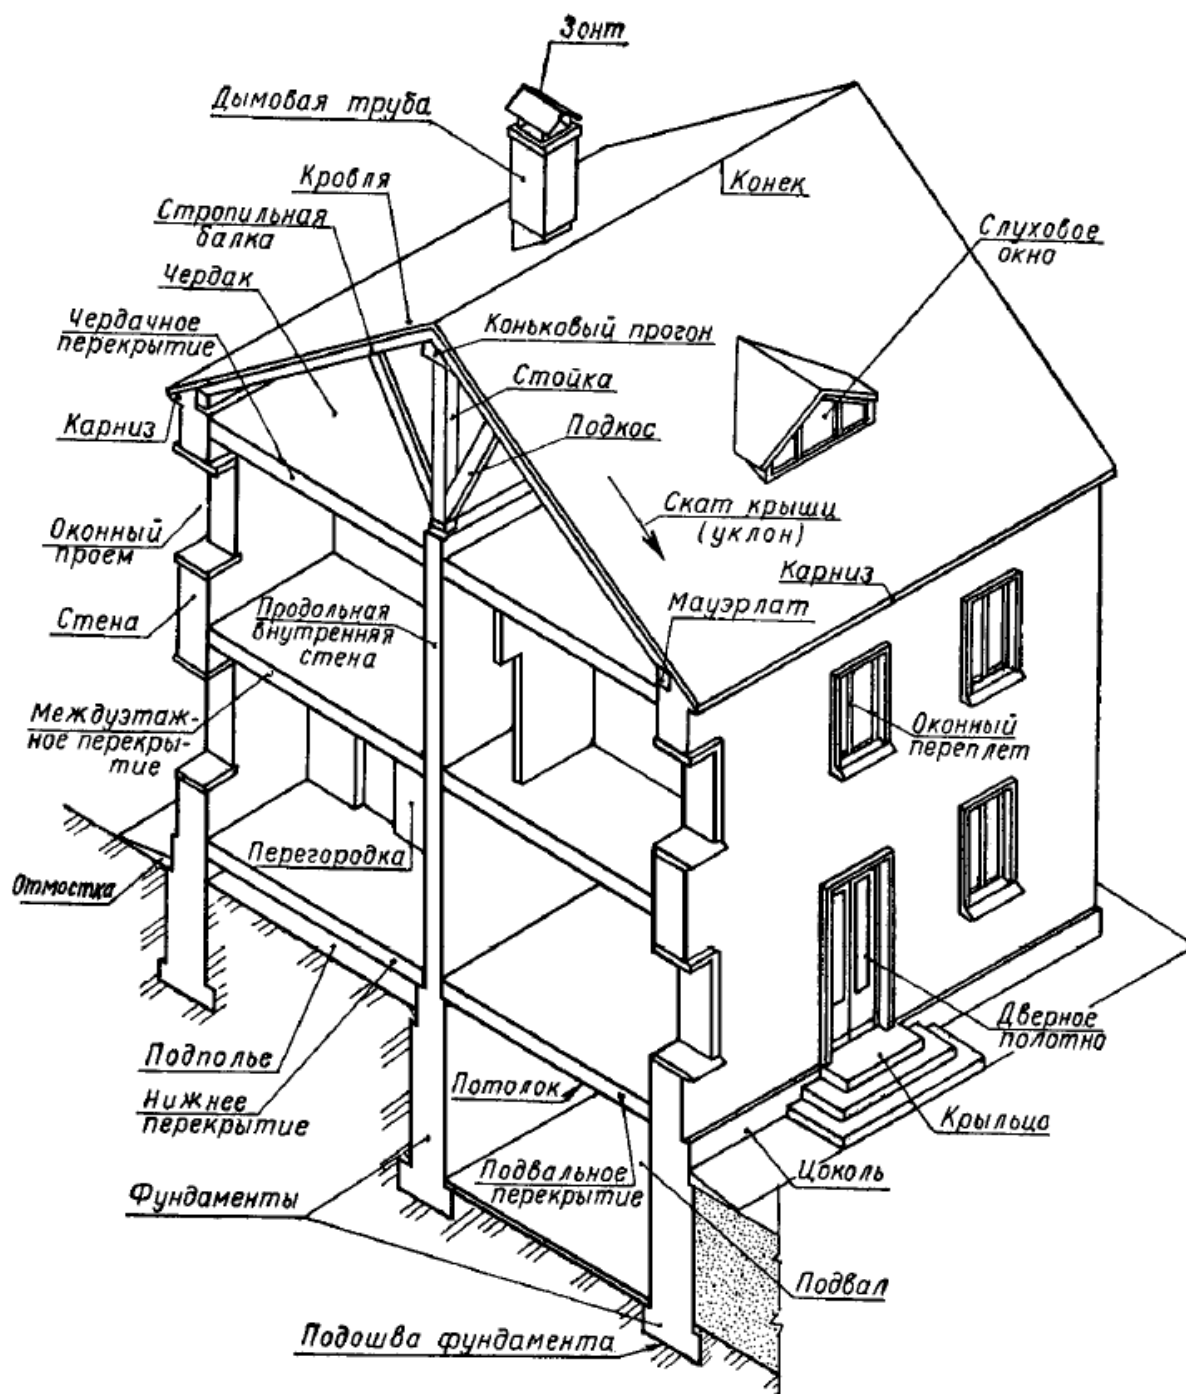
Конструктивные элементы здания с кирпичными стенами
